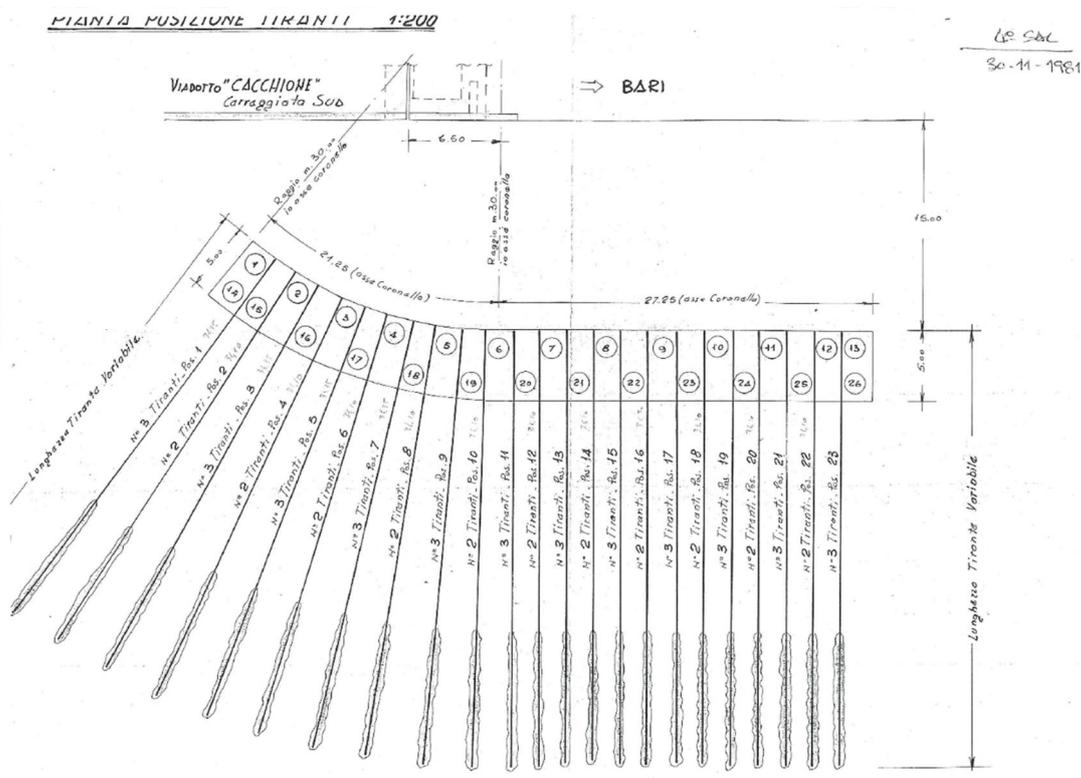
Viadotto Cacchione – Paratia di pali a protezione delle Spalle lato Bari - Planimetria (Doc.Ref.[7] e [18])
